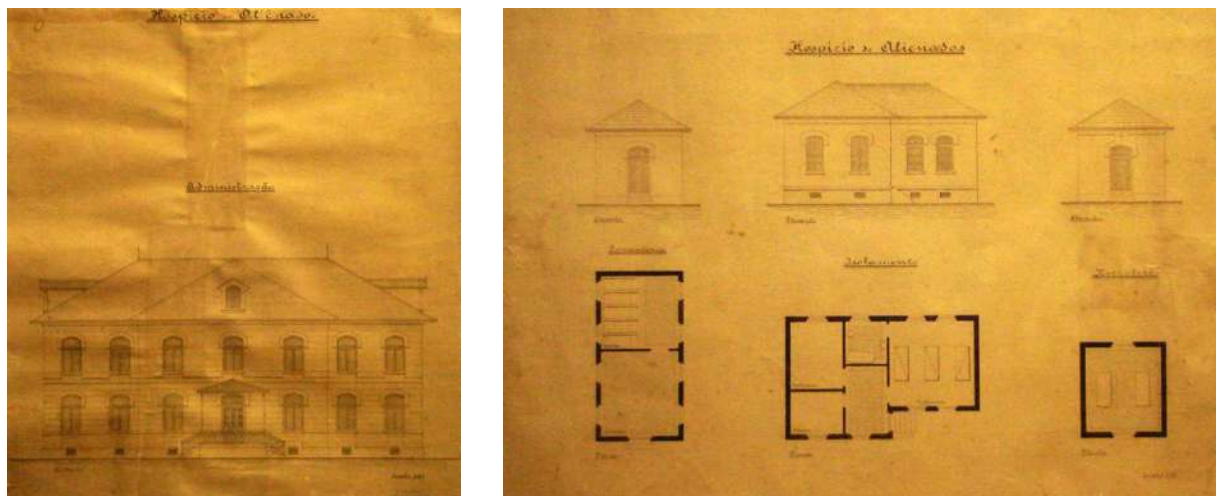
e 246 – Plantas e elevações referentes aos pavilhões de administração, lavanderia, isolamento e necrotério (acervo do Museu Osório César);
